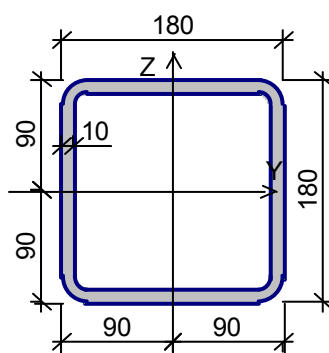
Принятое поперечно сечение раскосов фермы
